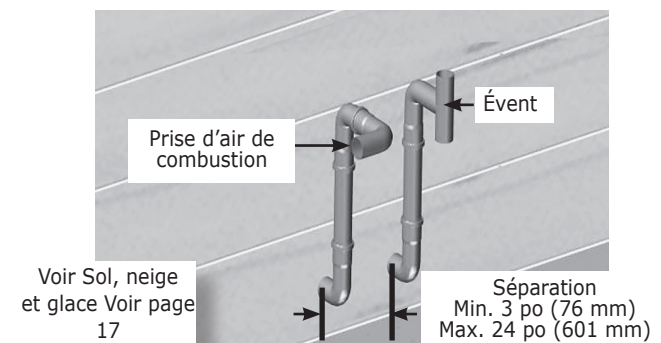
(2 po[60 MM] ET 3po[80 MM]) PIPE DE BOUCHE W/HORIZONTAL T
